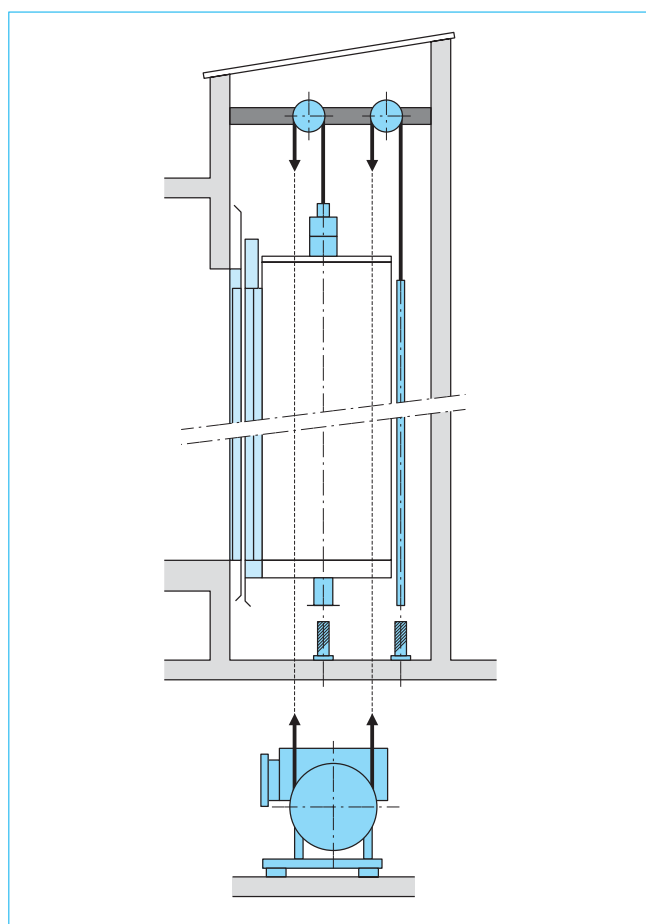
Installation à adhérence avec contrepoids (immeuble existant)
